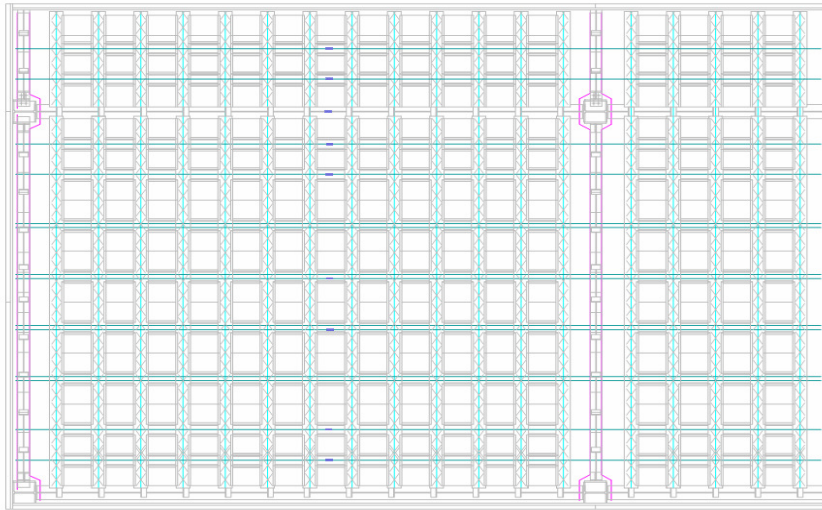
Posicionamento dos extensômetros nas armaduras positiva
